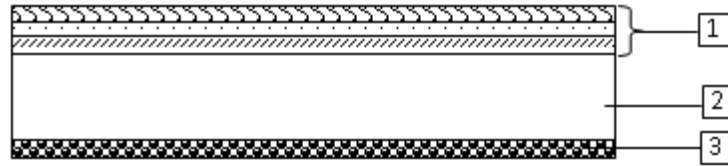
Section transversale d'un plancher à dalle pleine.
